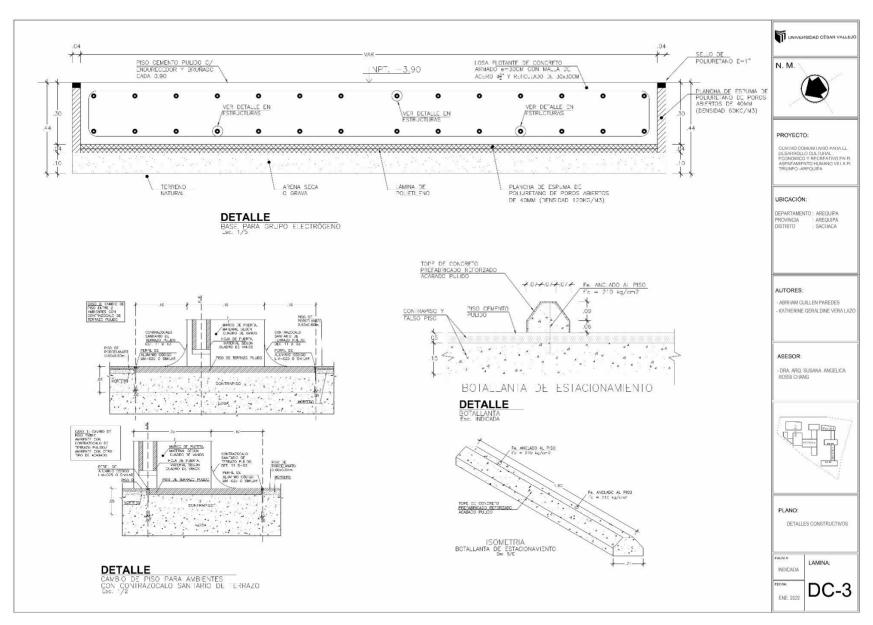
Plano de Detalles Constructivos (Acabados I) - Elaboración propia
